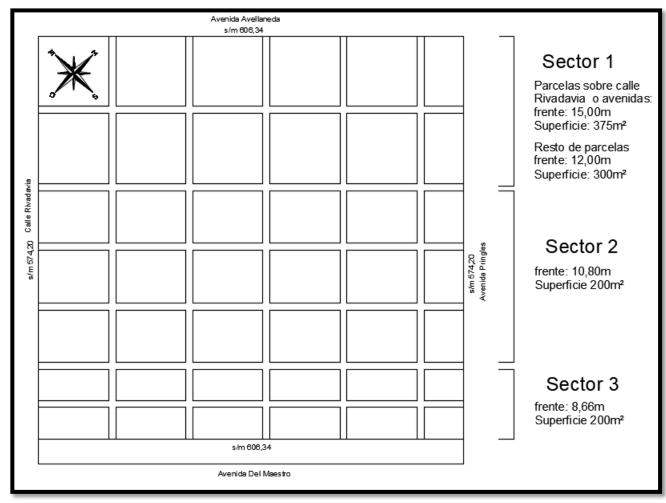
Croquis de Subdivisión Elaboración: Propia (AutoCAD)
